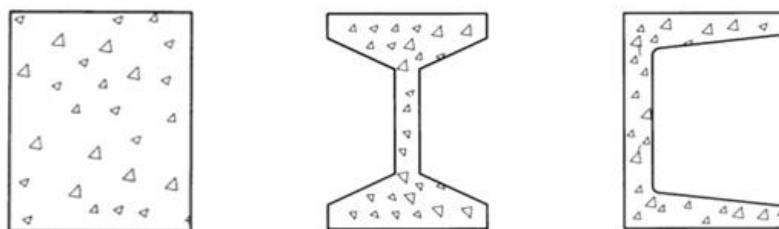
Secção genérica da cabeça e secções transversais em I ou em U, respetivamente (DMA-C67-205/N, 2000).
